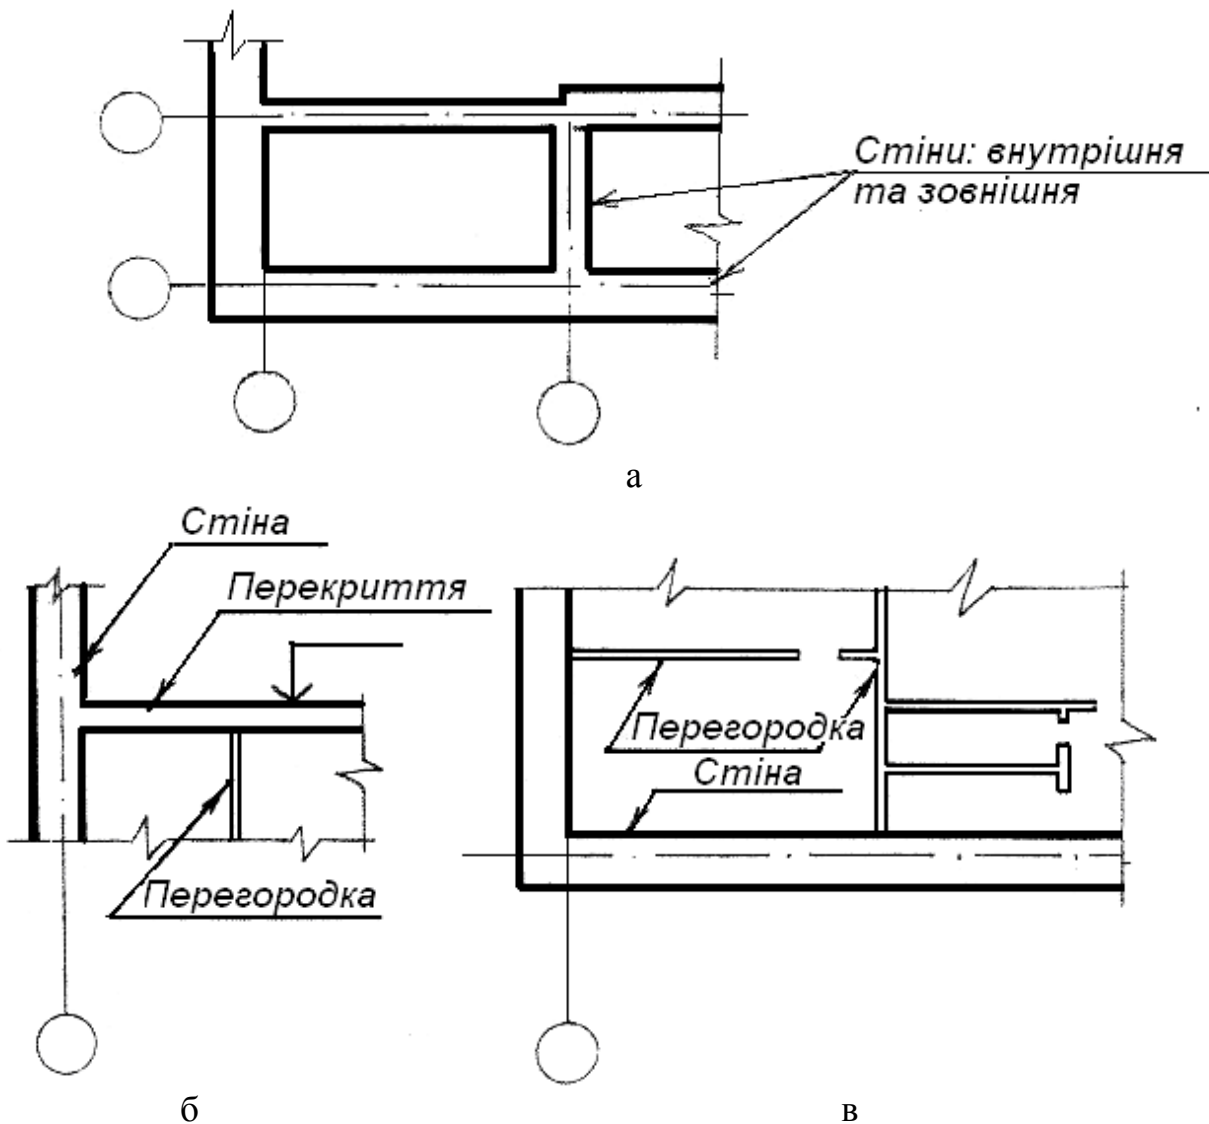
Прийняті позначення прилягання: а – зовнішніх і внутрішніх стін як безперервного мурування (на плані); б – прилягання перегородок і перекрыття до стіни (у розрізі); в – прилягання перегородок до стін і одна до одної (на плані)
